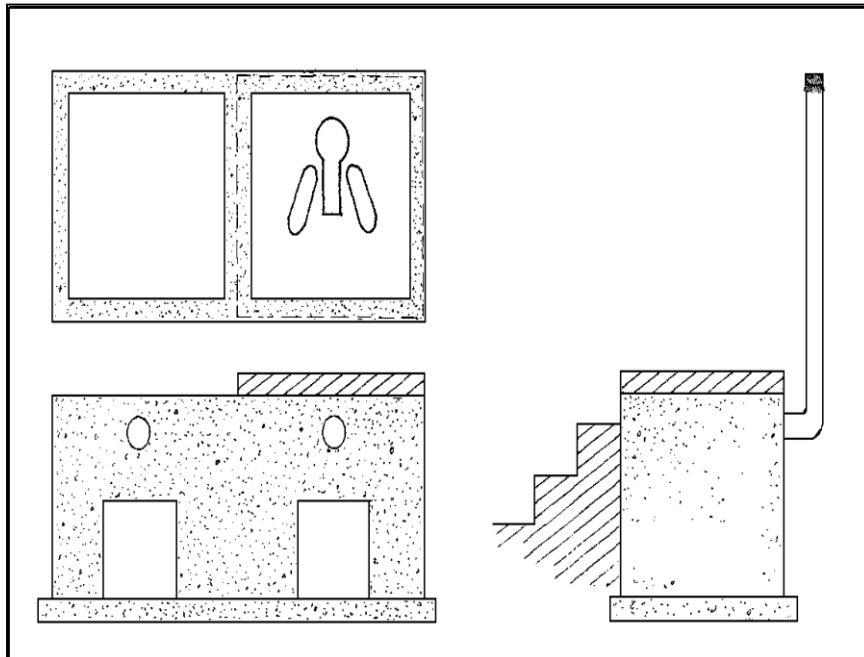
Vista de planta y perfil letrina de pozo seco ventilada
